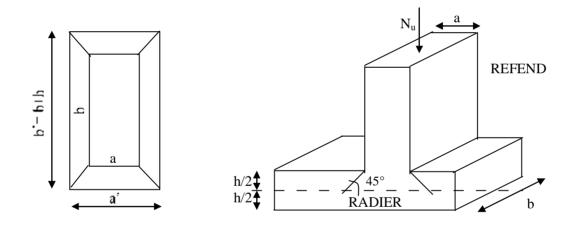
Périmètre utile des voiles et des poteaux
